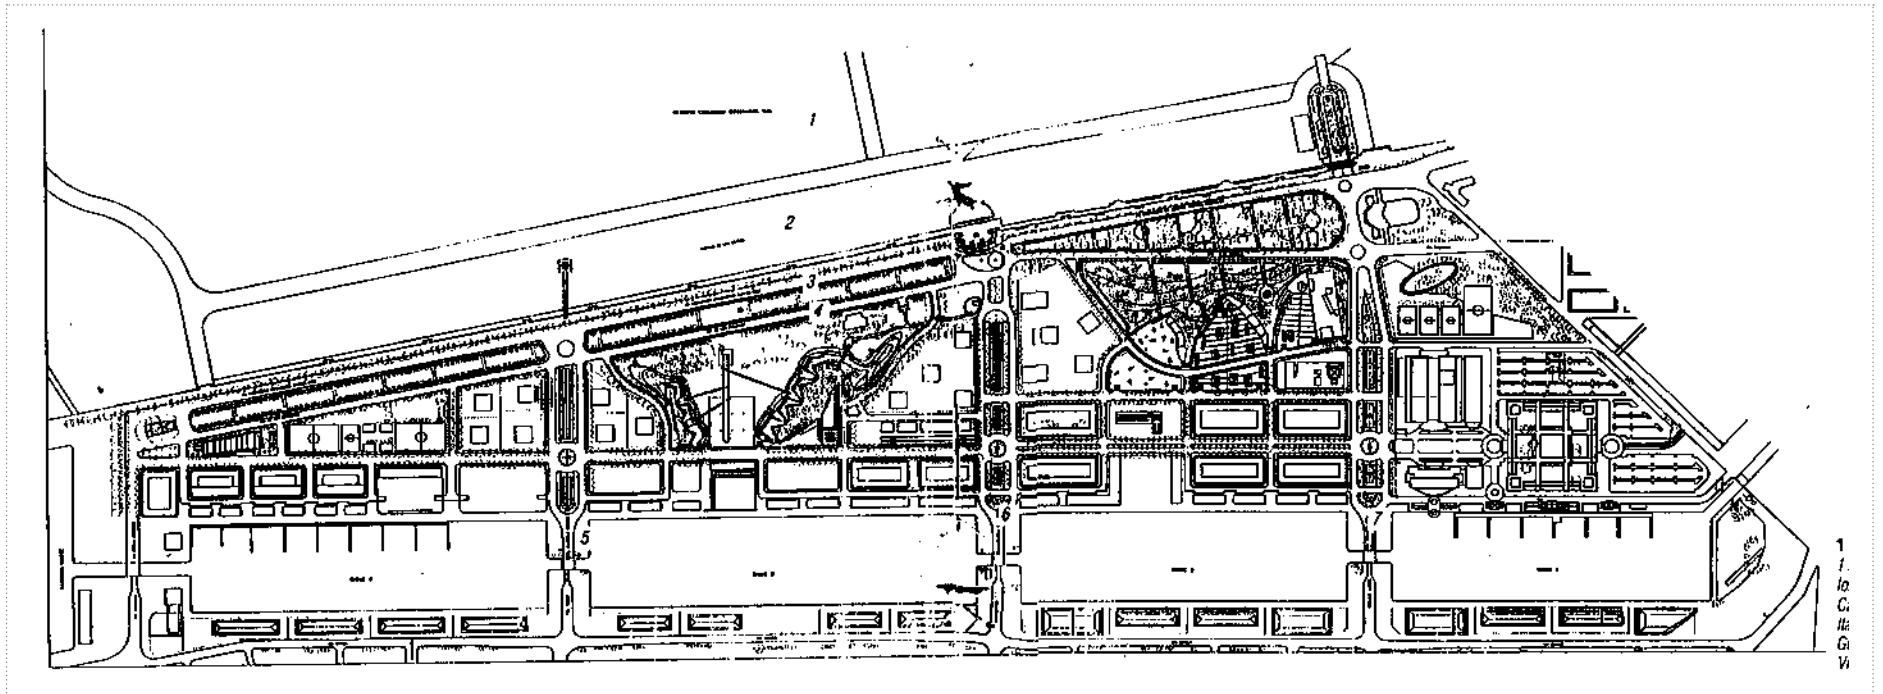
Implantação da proposta para as áreas verdes do Puerto Madero.
